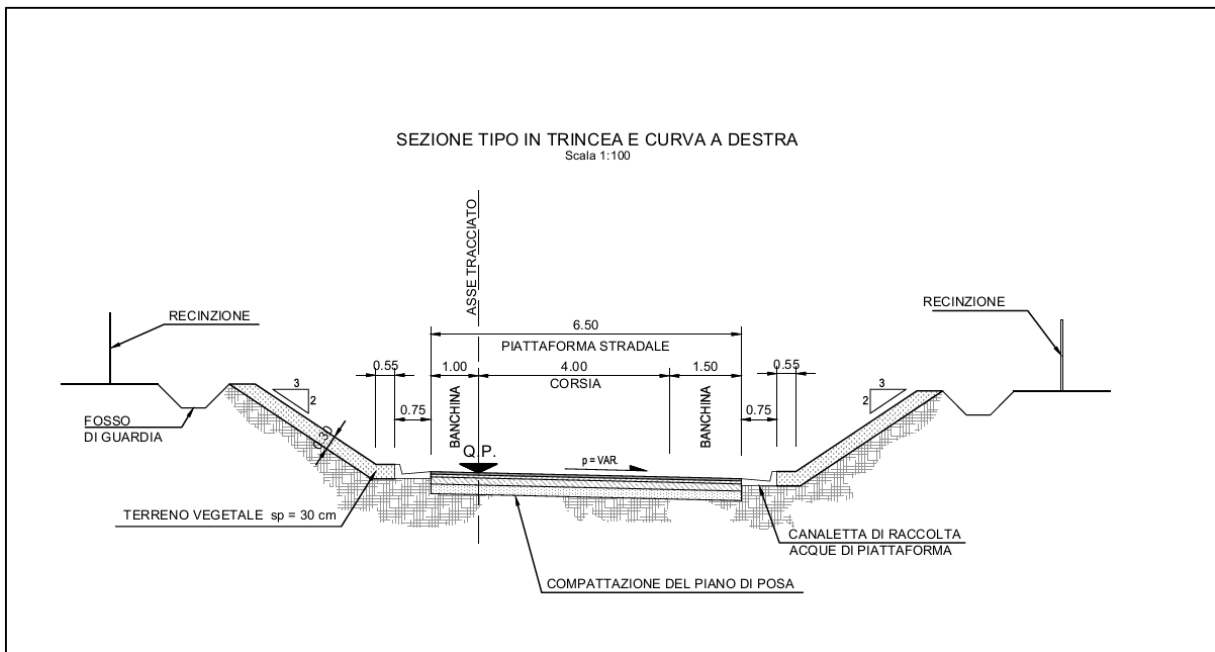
Sezione tipo rampa monodirezionale - sezione tipo in trincea
